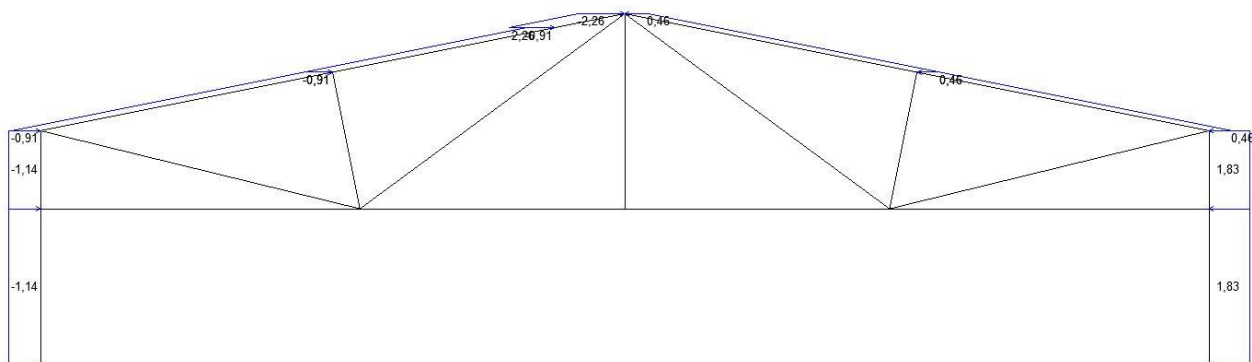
Ветровая нагрузка на ферму и колонну, вариант 2
